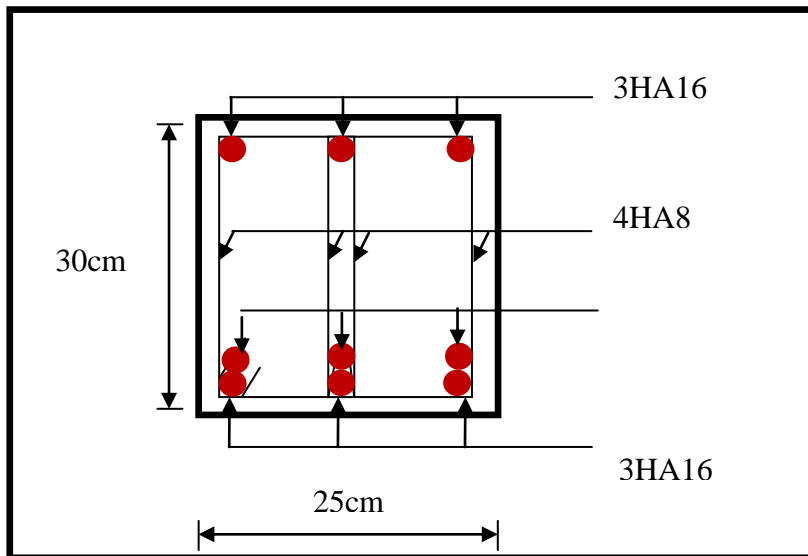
Ferrailage en travée d'une poutre secondaire.
